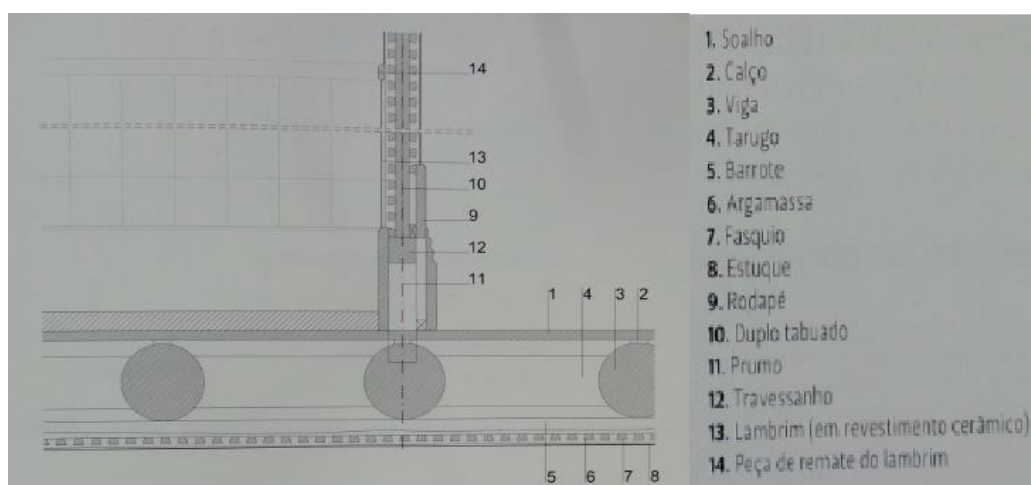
Pormenor construtivo do pavimento de madeira / parede interior em zona húmida [6]
